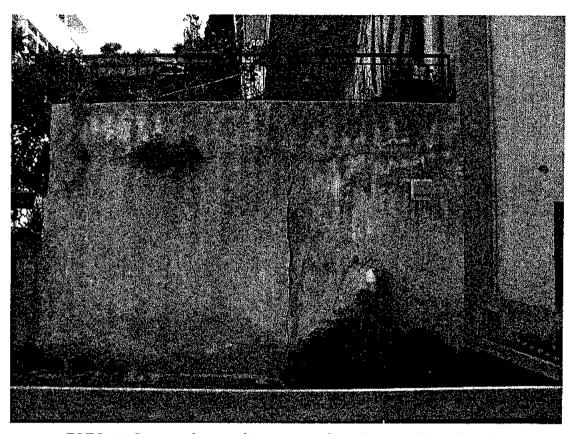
Crepe nel muro di sostegno al confine con il parcheggio
